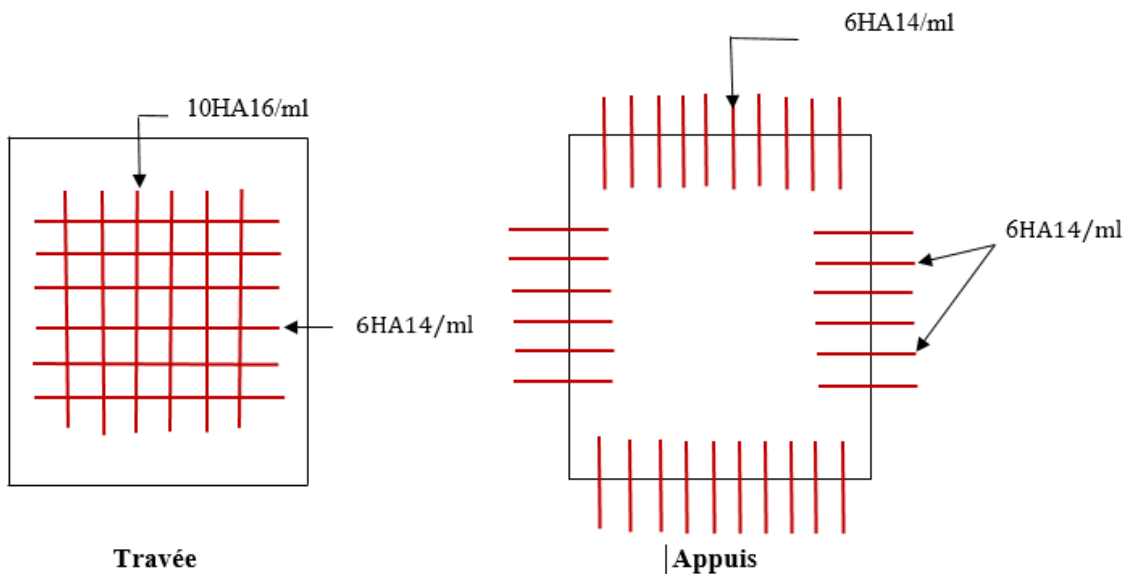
Schéma de ferrailage d'un panneau de rive.
